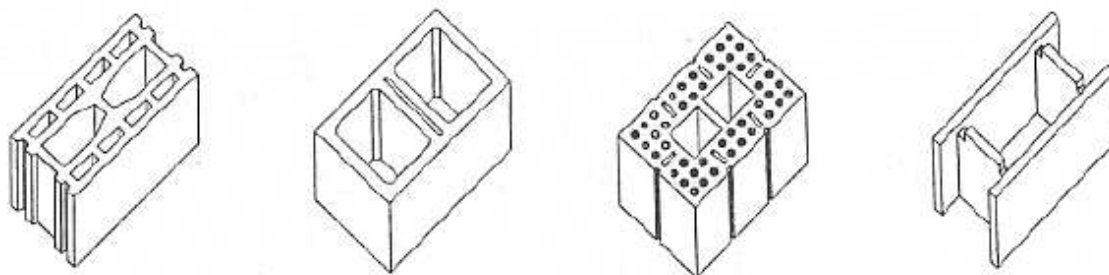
Esempi di elementi murari in calcestruzzo
